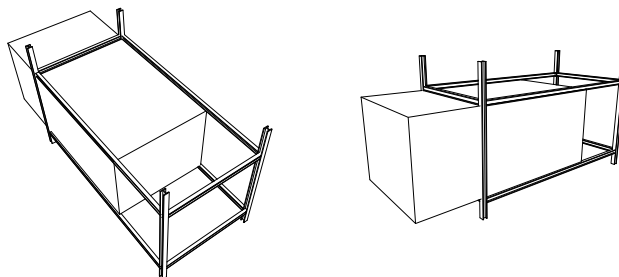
Relação Módulo – Estrutura Metálica. S/ esc.
